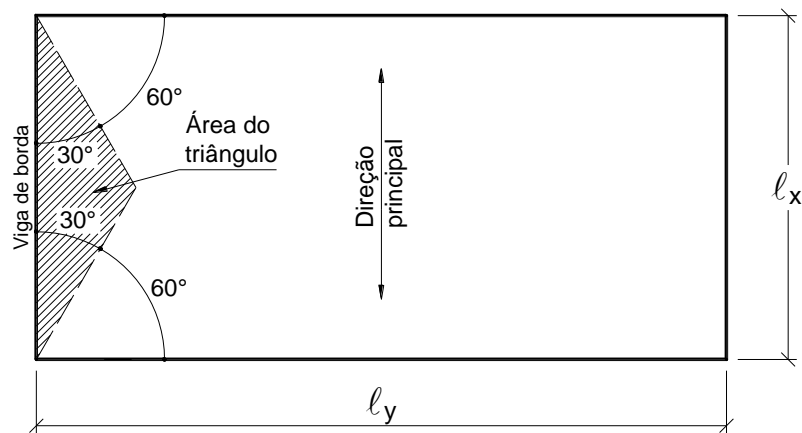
Carga nas vigas laterais paralelas à direção principal da laje armada em uma direção.
